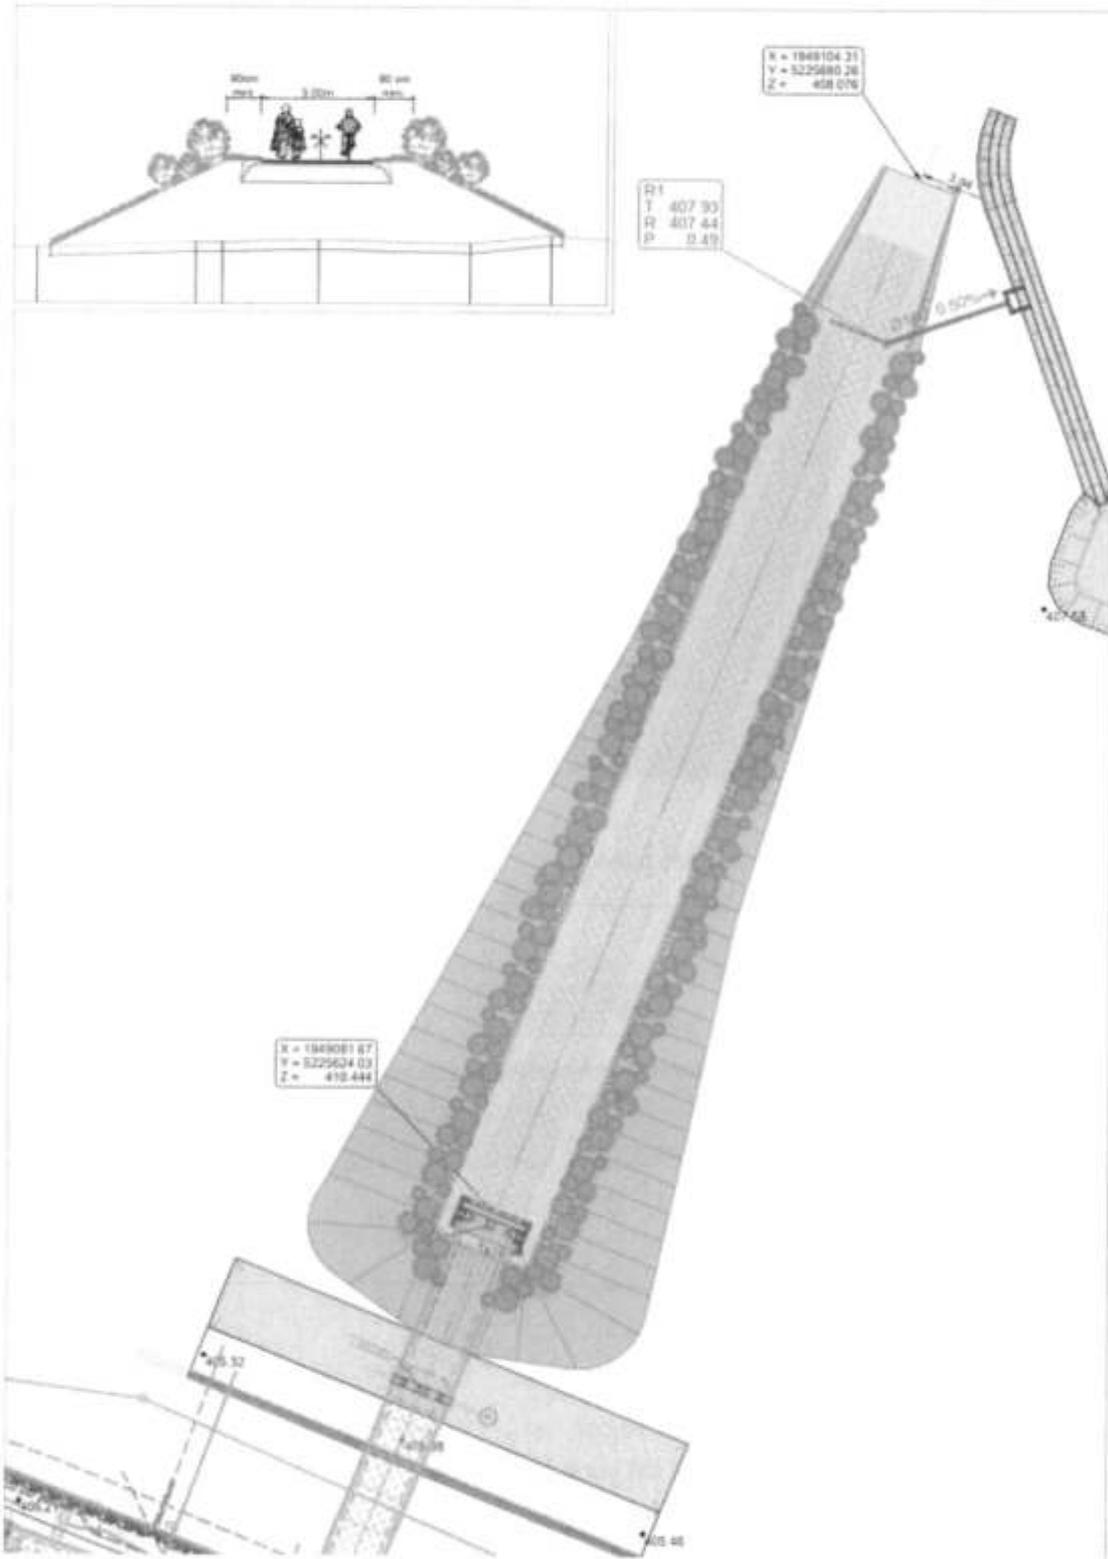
Zoom sur la rampe d'accès à la passerelle
